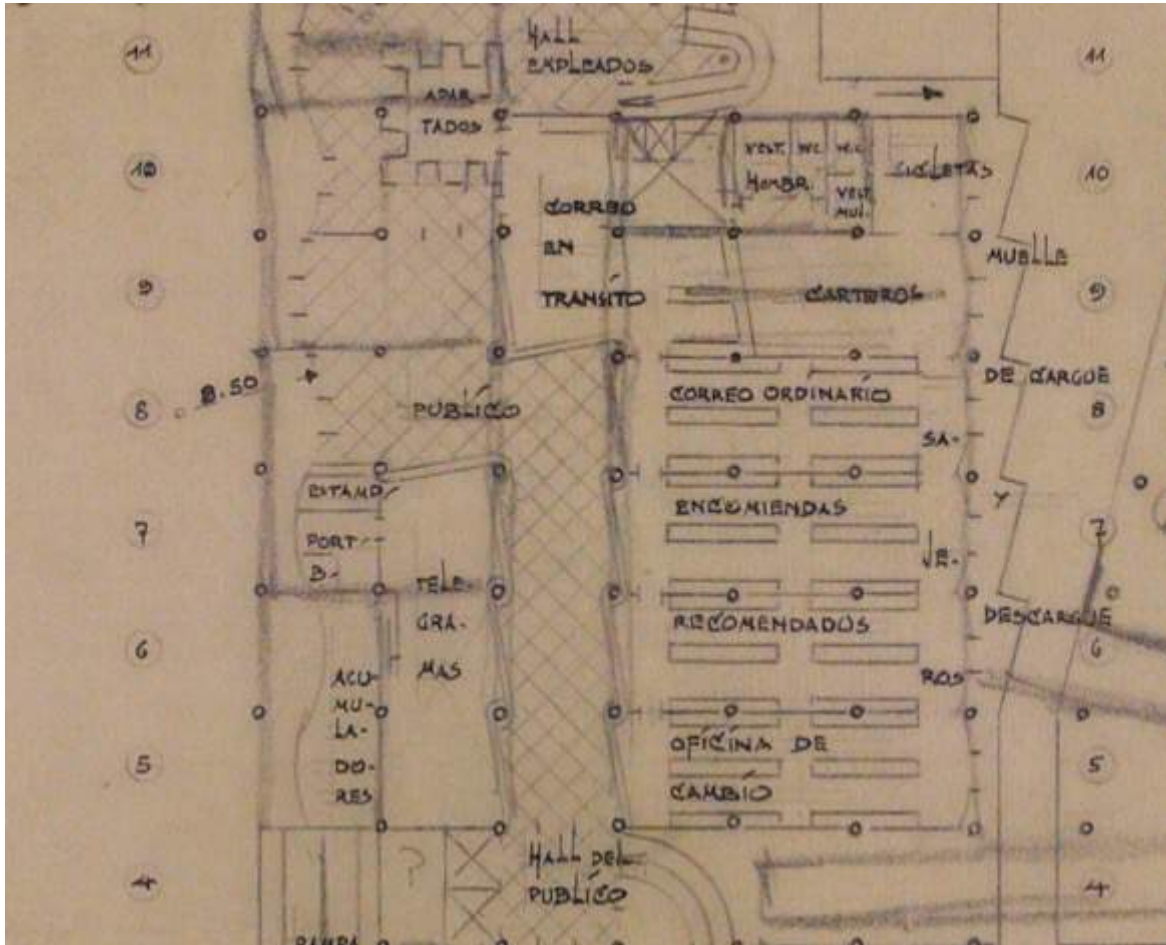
Croquis autógrafo de Rother, para la primera planta del Edificio Nacional. (Archivo General de la Nación. Fondo Invías. Plano no. 364. 23.07.1946. Signatura -1, 01, 16, 19. Fragmento.)
